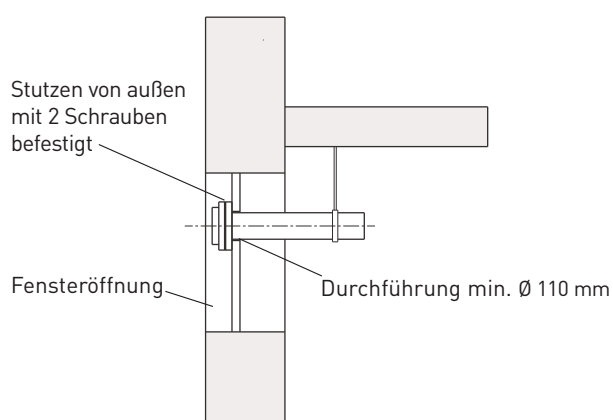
Stützen Fensterdurchführung – Seitenansicht
